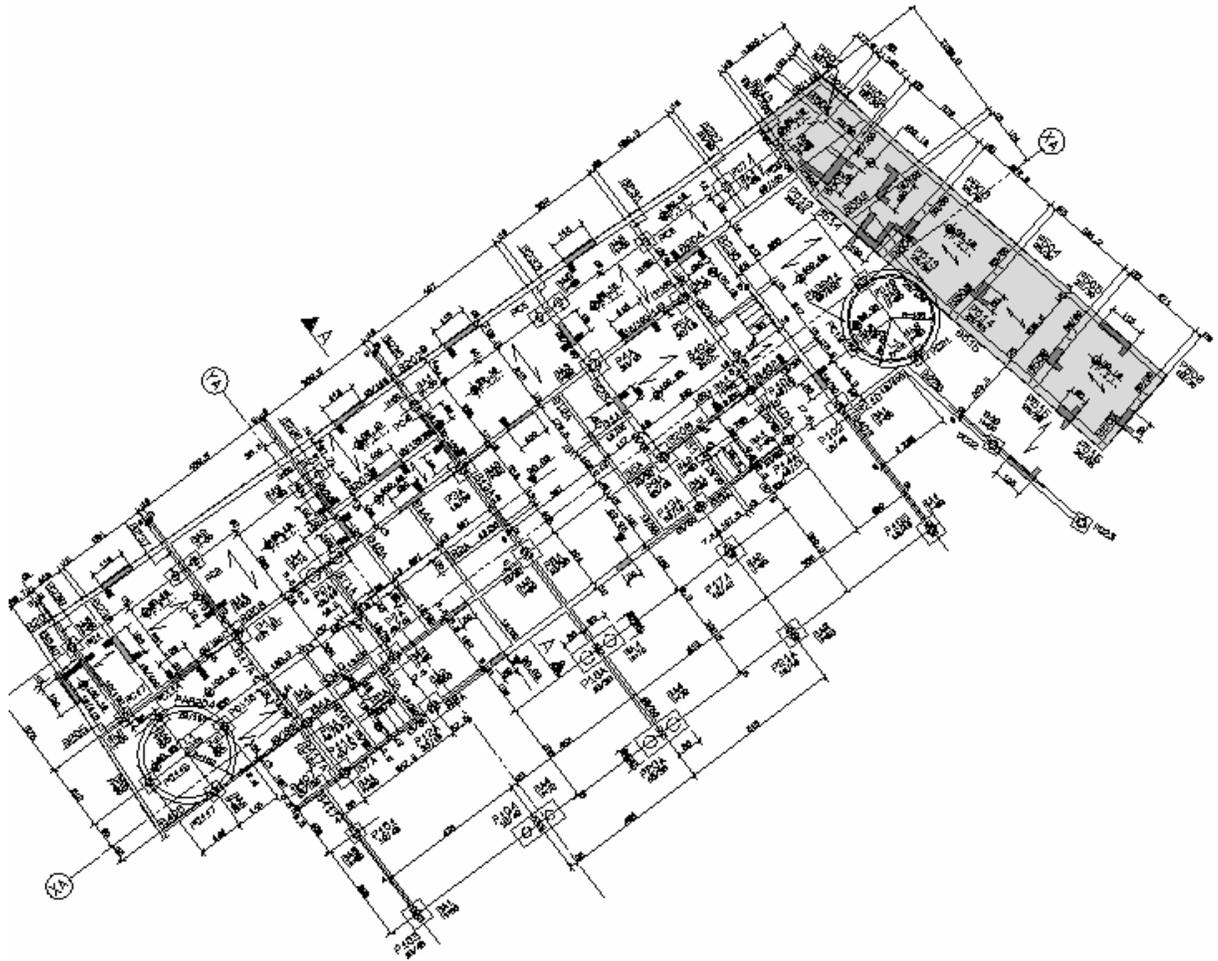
Detalhe da fôrma da fundação bloco A
